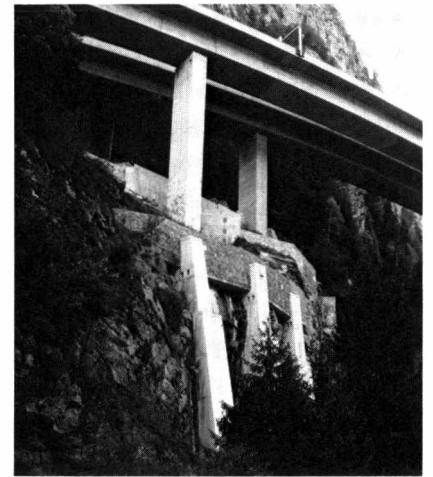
Die drei verankerten Stützpfeiler unter dem Fundament 2' – Les trois supports avec ancrages sous la fondation 2' – Three anchored supports under foundation 2'
